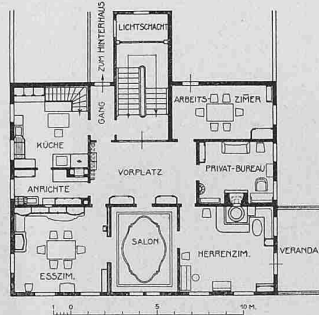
Wohnhaus-Umbau Stähelin in Wattwil. — Grundriss 1:400.
